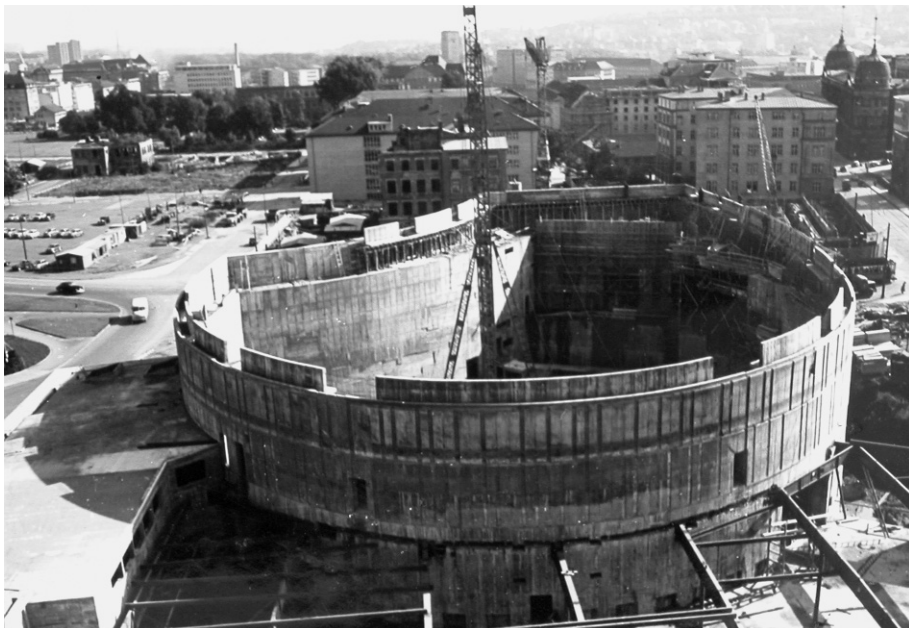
Rohbau Beethovensaal mit zweischaliger Stahlbetonkonstruktion, Büro Gutbrod, 1955.
